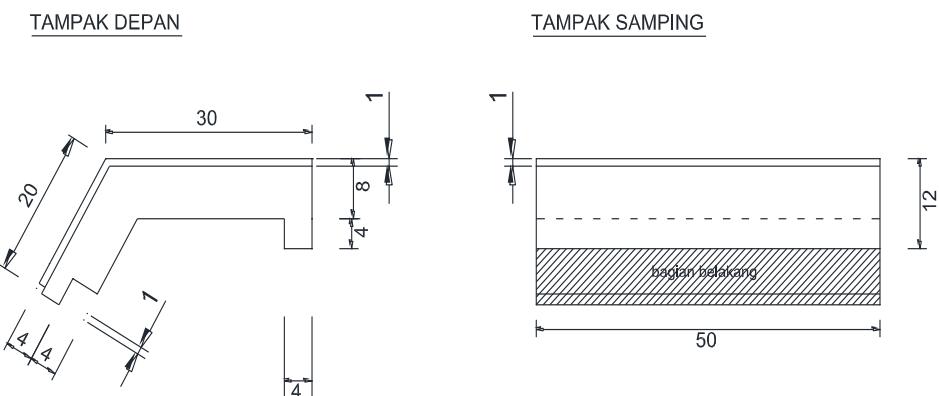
Modul Dinding atau Lantai Tipe-S Beton Pracetak Modular
